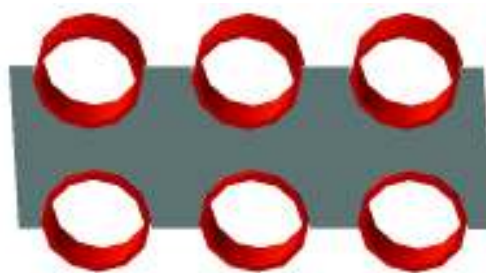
Banco de ductos con separadores para 6 cables [14].
